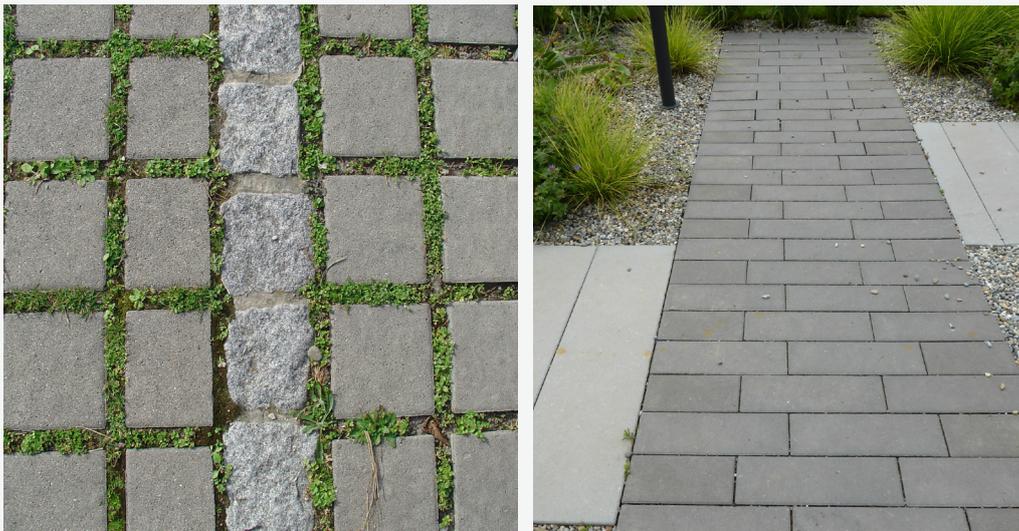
Links Kombination Beton- und Naturstein, rechts Zugangsbereich aus Betonplatten
